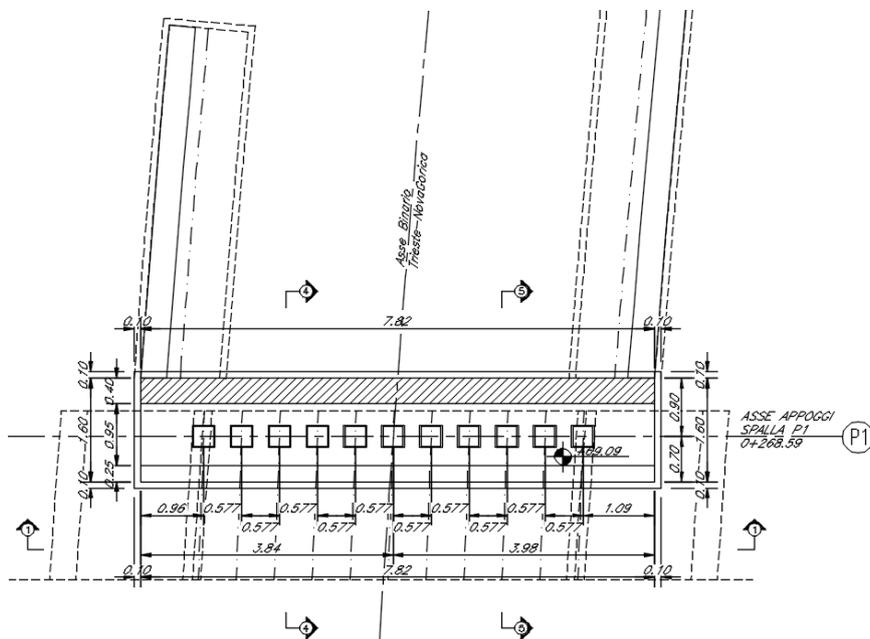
Spalla P1 - Sezione orizzontale 3-3 (sezione a quota appoggi)
